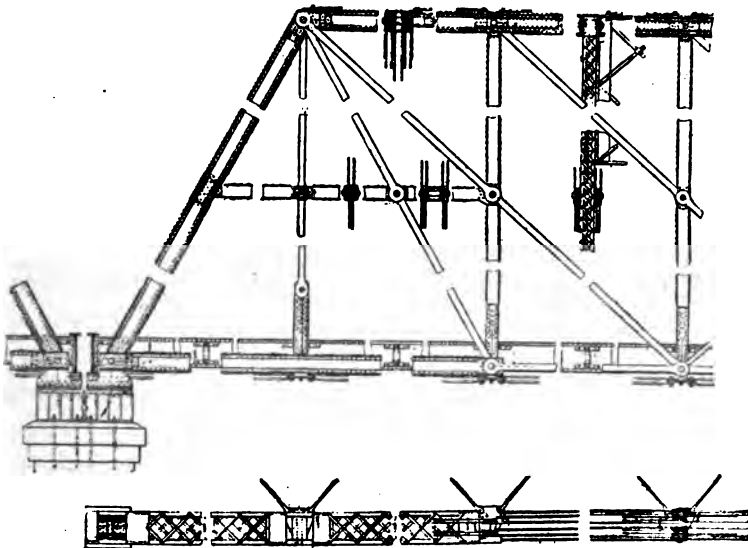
et 260. — Modifications apportées aux premiers Panneaux d'une Poutre Linville de 75^m, 11 (Pont d'Omaha).
